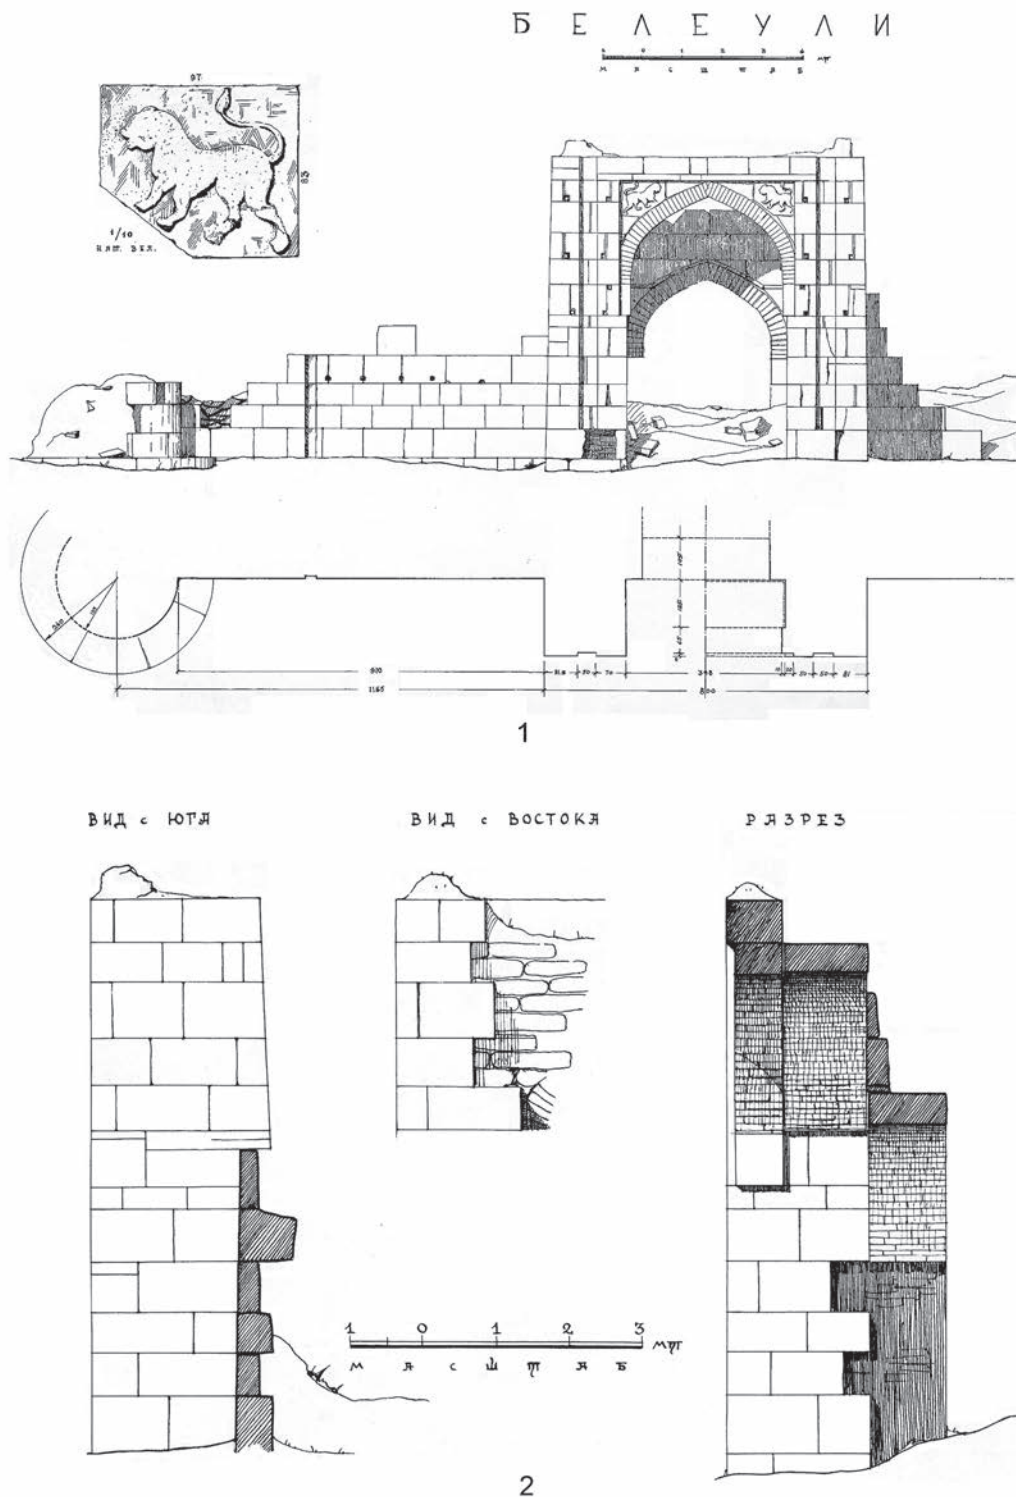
Белеули: 1 – фасад и абрис порталной стены; 2 – виды сбоку и разрез портала (черт. арх. В. И.Пентмана архив ИЭА РАН, фонд 142).
